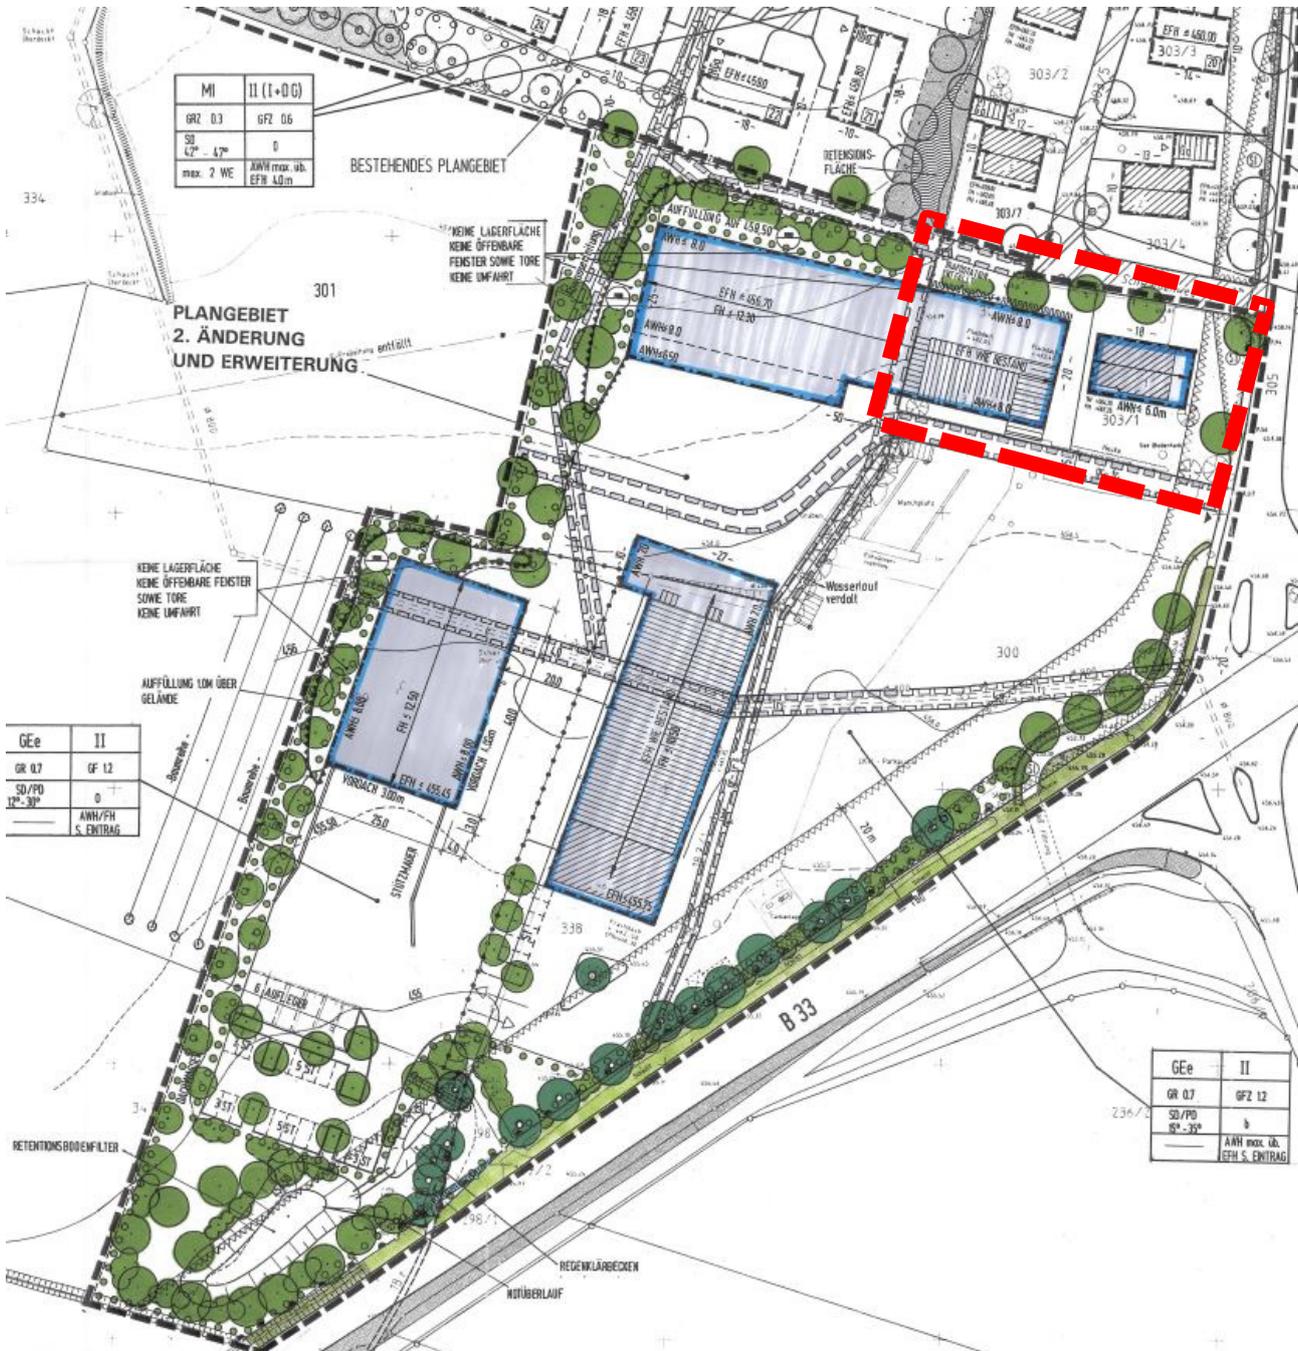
Rechtskräftiger Bebauungsplan mit Kennzeichnung Änderungsbereich (rot gestrichelt)
